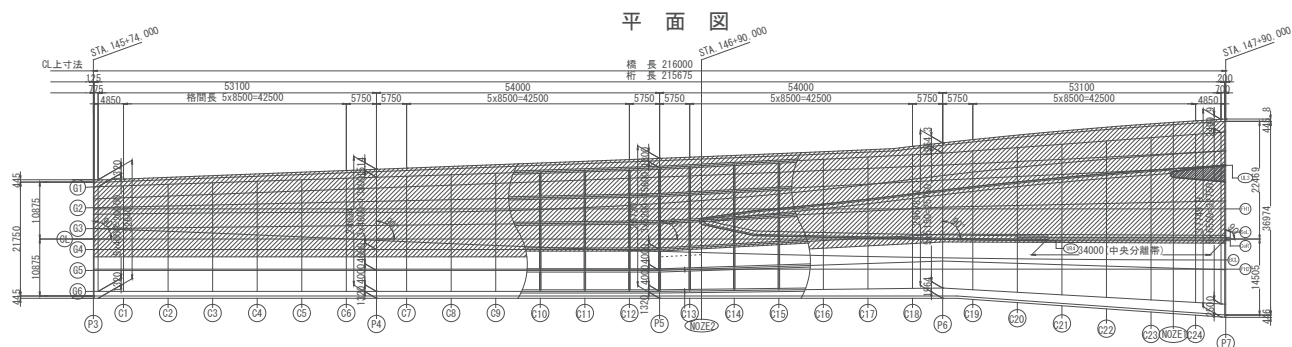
津田高架橋 平面図（ハッチングは暫定形範囲を示す）
